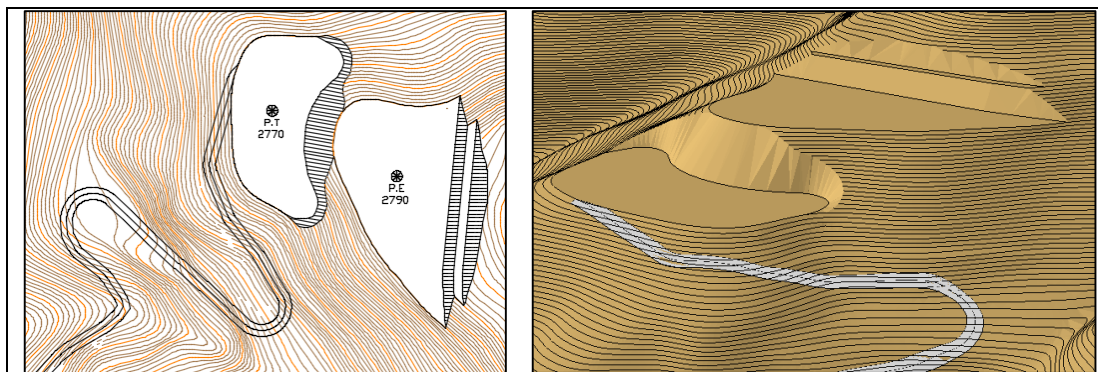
Vista en planta y en 3D de la Fase 2 de explotación.
